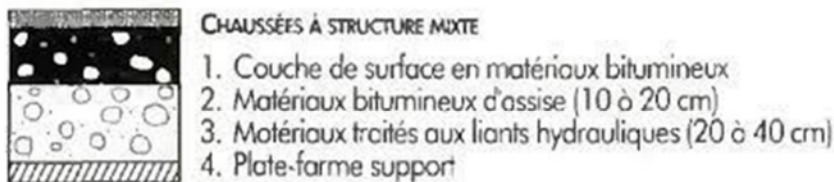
Coupe type d'une chaussée mixte (Chibani (2017)).
